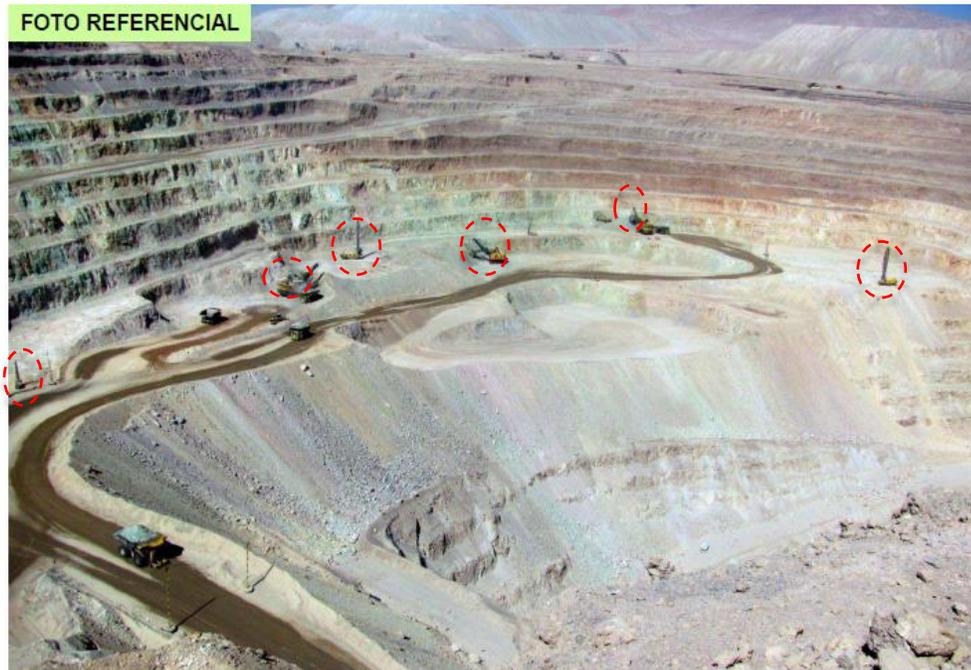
Foto fase 18, banco angosto con 5 equipos
